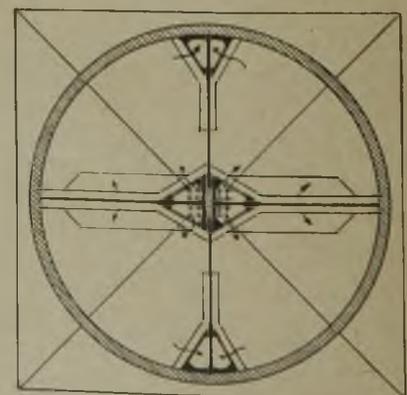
u. 4. Schnitt und Grundriß eines Iffa-Kornturmes.
